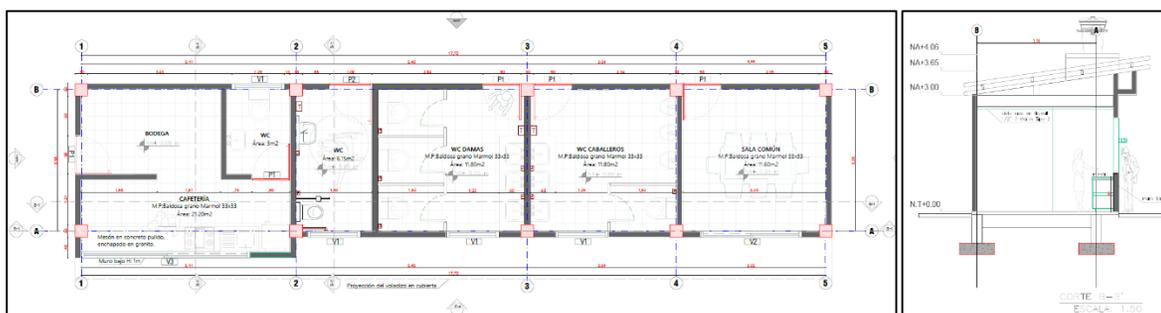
Planta y Corte Arquitectónico Lateral Zona de Baños y Cafetería
